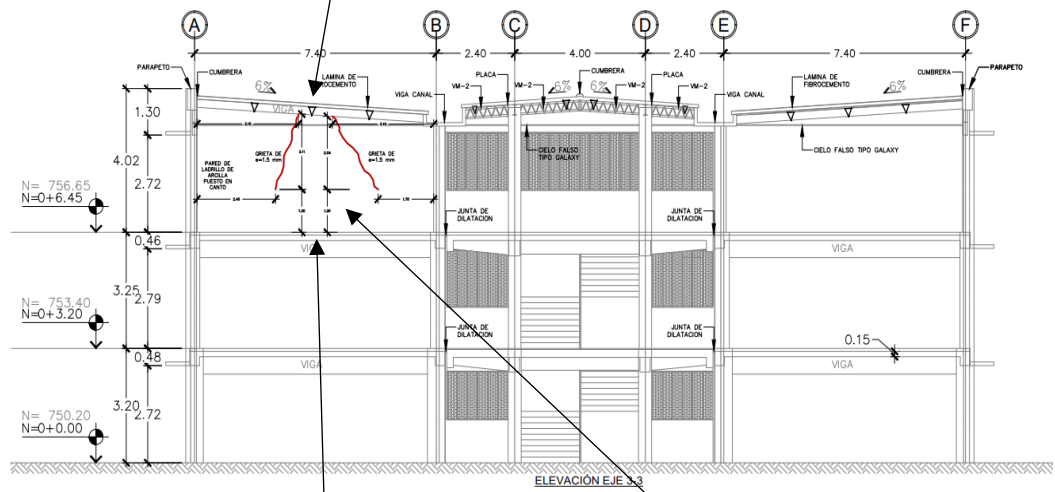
Esquema de daños en pared de mampostería de ladrillo de barro, tercer nivel, eje 3-3, tramo A-B.
